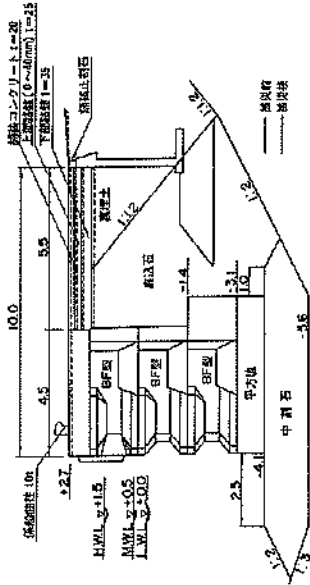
被災状況図 (知人町地区, ⑤物掃場 (-4.0m))
